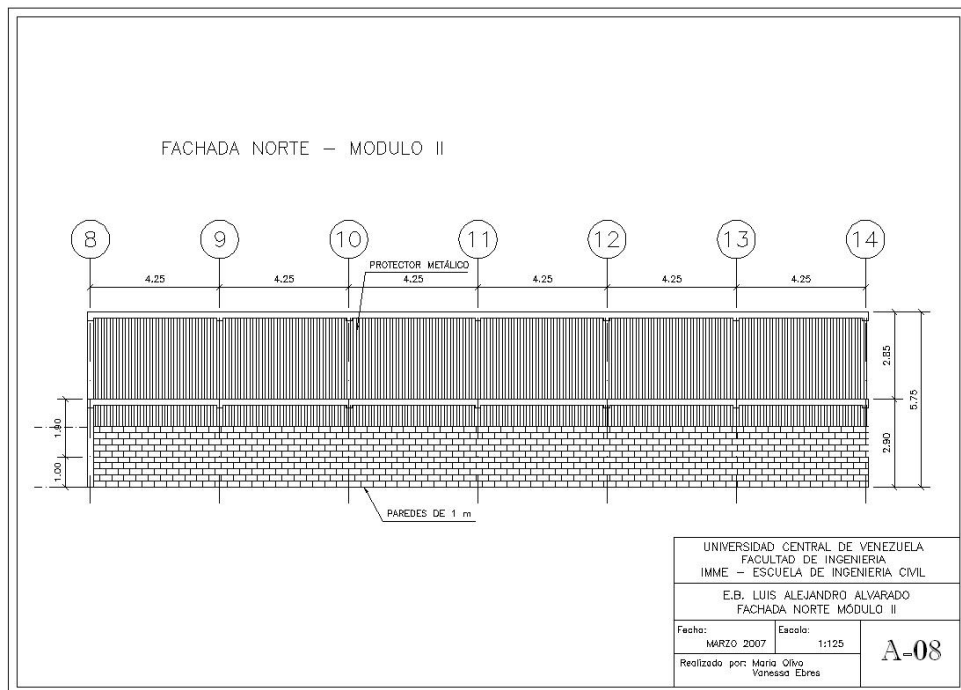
Plano de la Fachada Norte del Módulo II.
